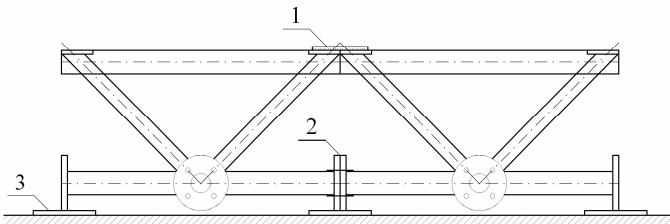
Схема монтажу збірного сталезалізобетонного покриття на рівні землі:
